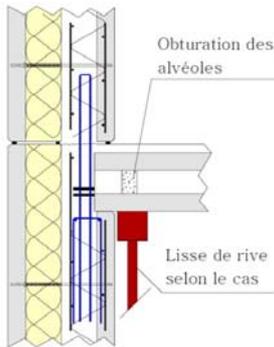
Dalle alvéolaire en appui de rive avec ou sans niveau supérieur
